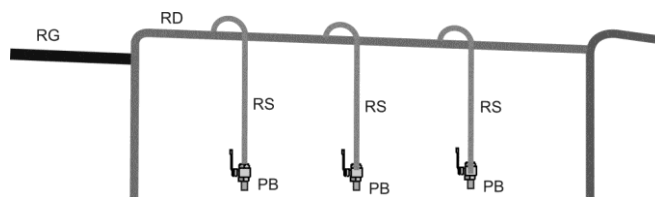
Schemat instalacji pneumatycznej typu zamkniętego - oczkowego
